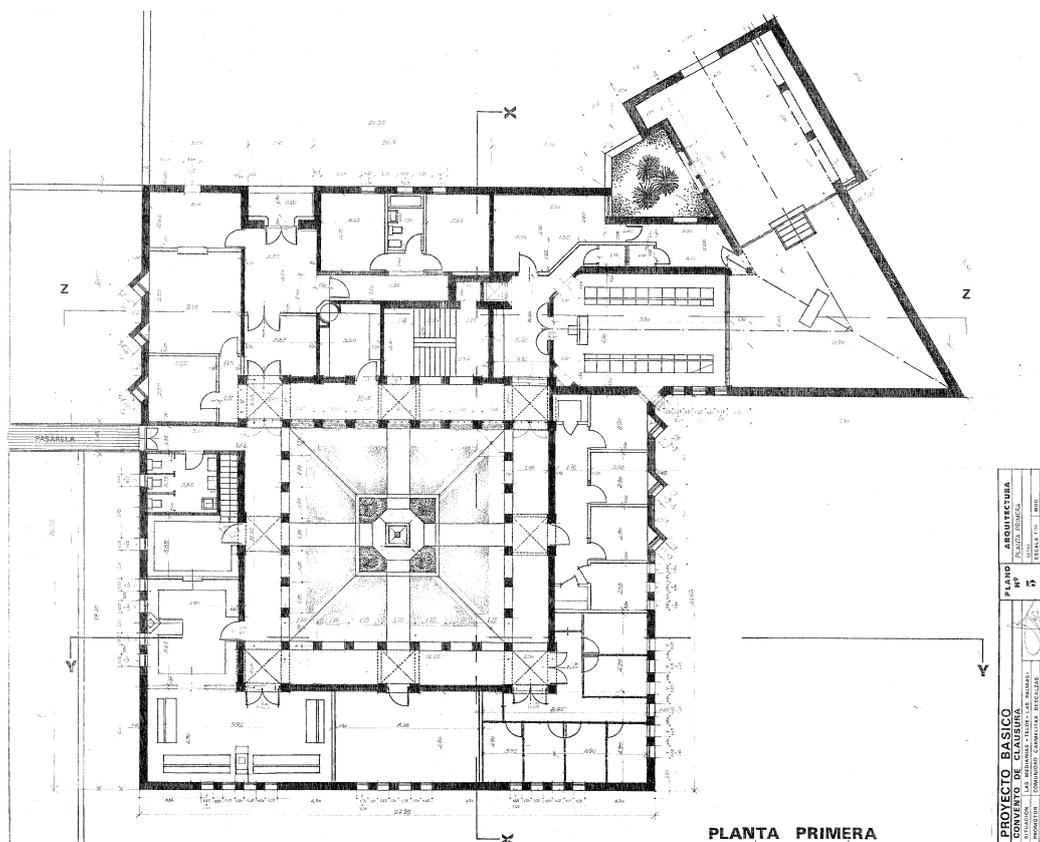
Convento Carmelita de Telde. Plano de planta primera.
